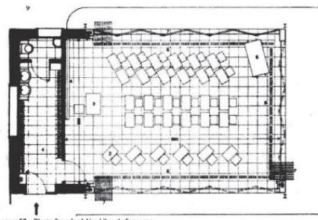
Planta Escuela al Aire Libre de Suresnes.
